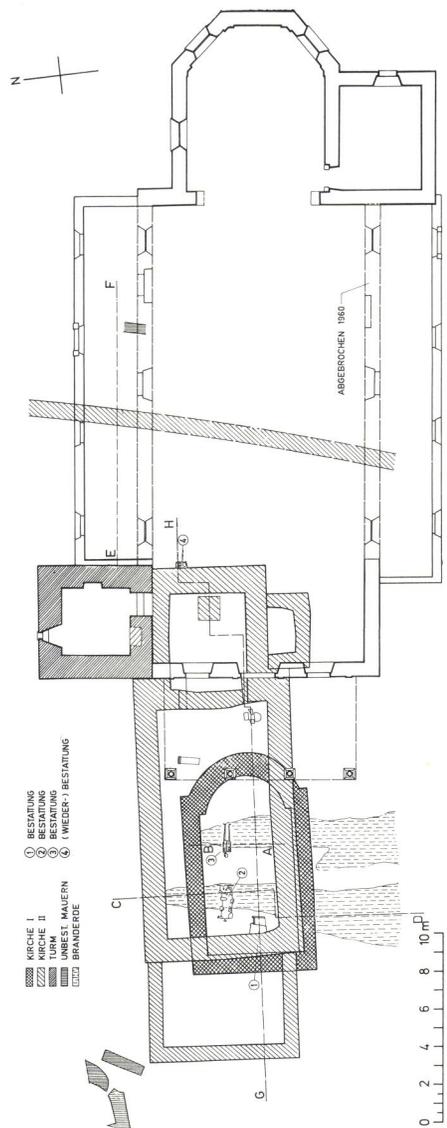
Altendorf. Kath. Pfarrkirche, Gesamtplan mit den Grundrissen der beiden Vorgängerbauten: Kirche II (romanisch, 12. Jh.) mit späteren Anbauten: Turm, Vorhalle und Beinhaus; Kirche I (frühromanisch, 11. Jh.). Nach H. R. Sennhauser.
